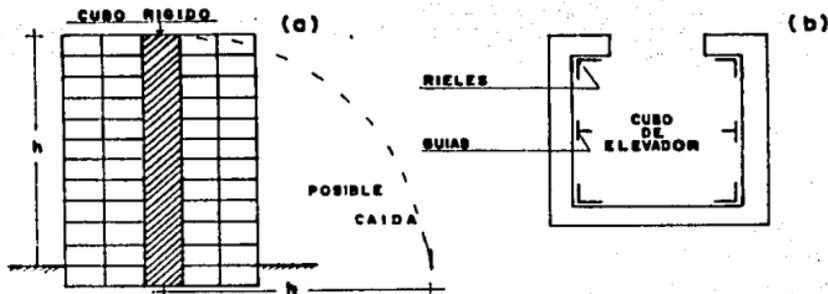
Efecto de los cubos de escaleras y elevadores.
